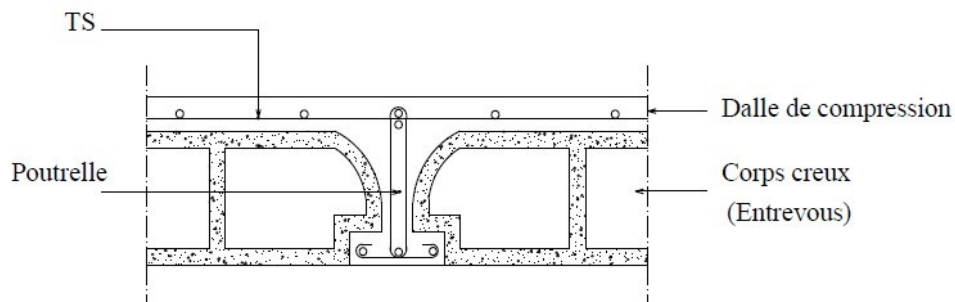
Coupe transversale d'un plancher à corps creux.
